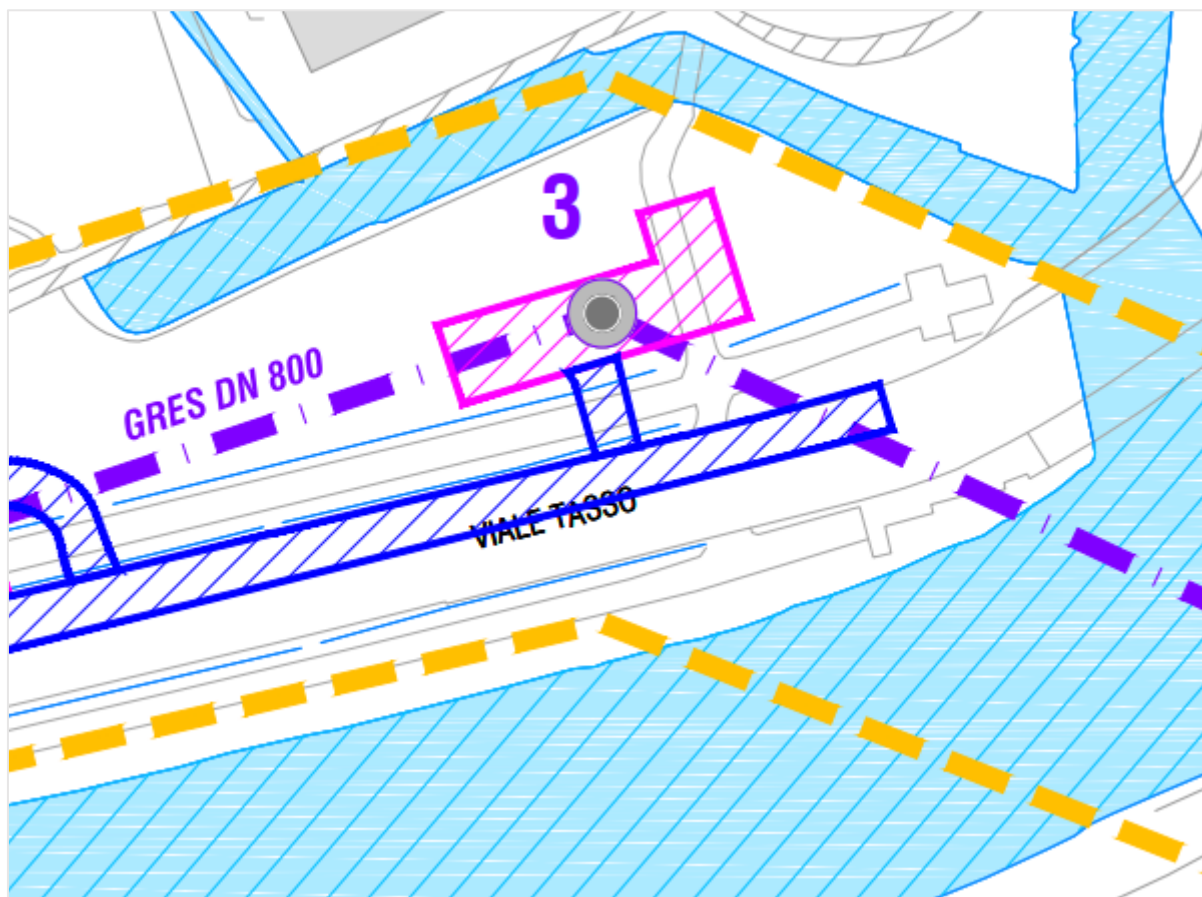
A : Inquadramento planimetrico area cantiere pozzo S3
